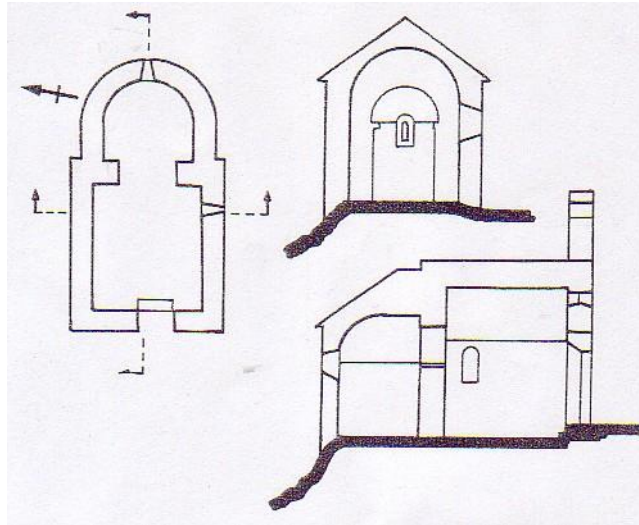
Plan et coupes BARRAL, 1981, p. 262.
